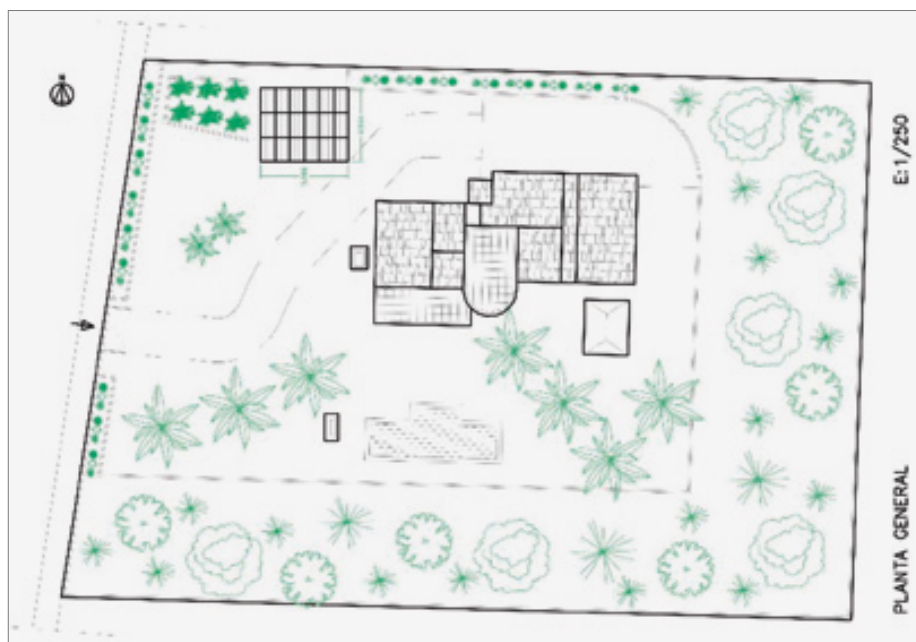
Vista en planta de la vivienda y de la instalación fotovoltaica a instalar
